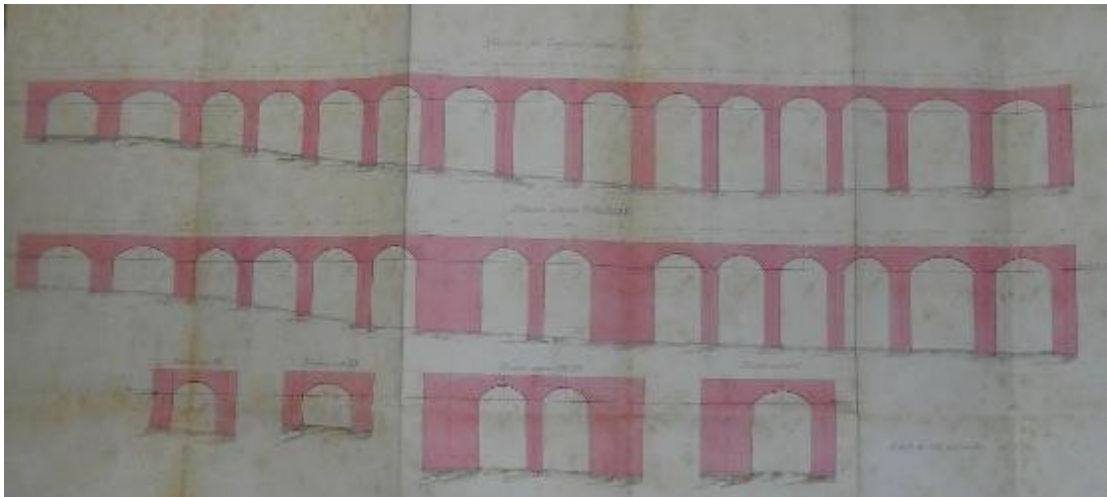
Plan des fondations du bâtiment-voyageurs de la gare d'Alger , Centre des archives SNTF, Alger.
